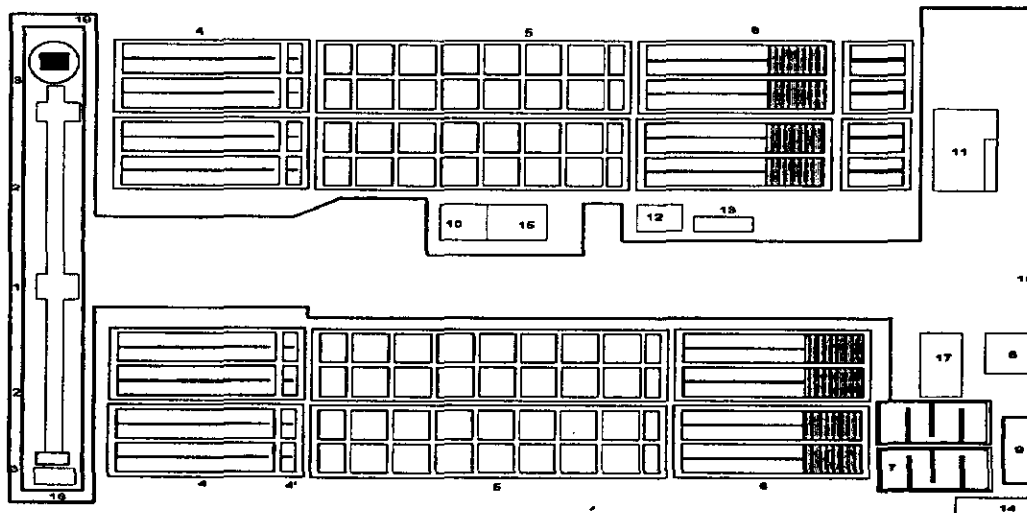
ESTRUCTURA GLOBAL DE LA PLANTA CERRO DE LA ESTRELLA
